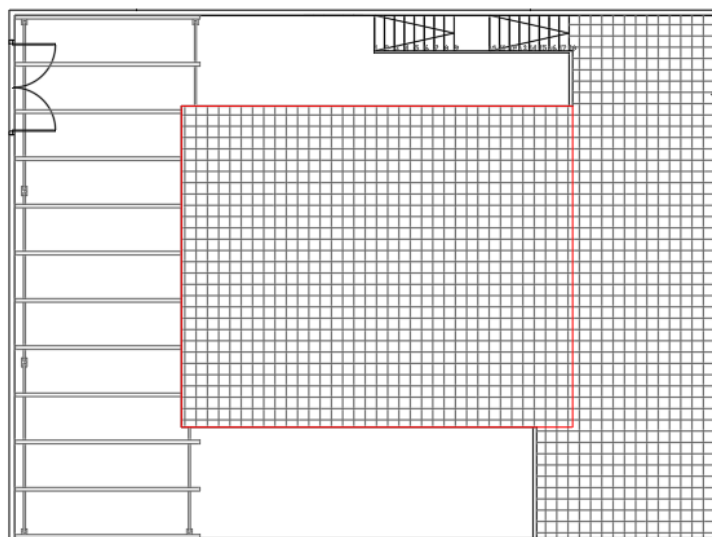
Planta de la vivienda y electrodo perimetral (en rojo)
